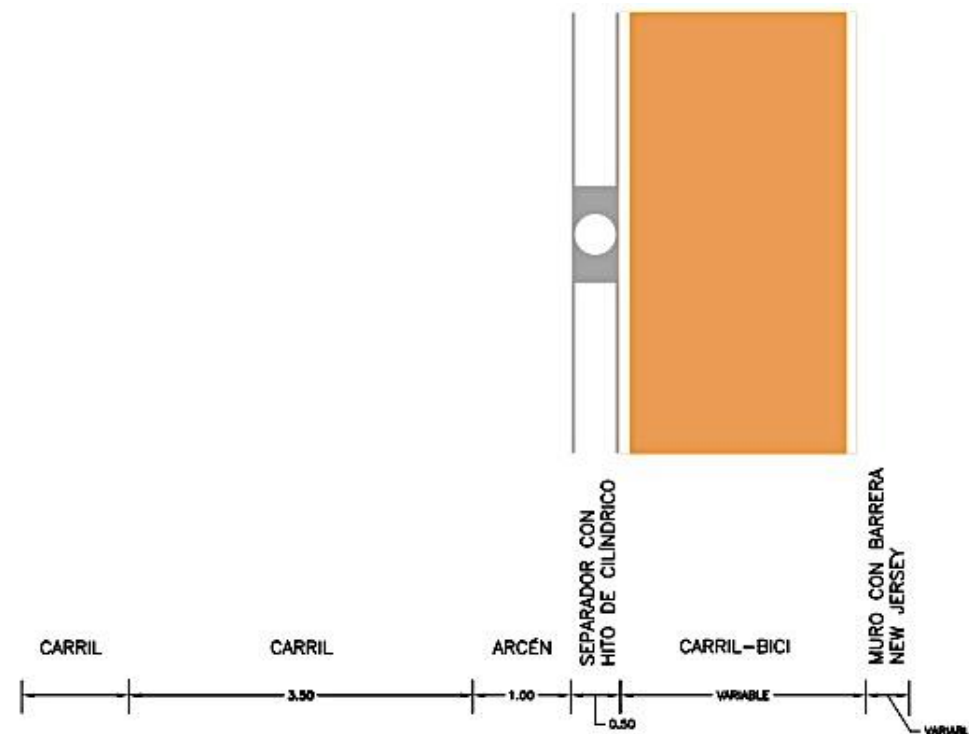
SECCIÓN TIPO CARRIL-BICI CON SEPARADOR CON HITO CILÍNDRICO Y MURO CON BARRERA NEW JERSEY.
